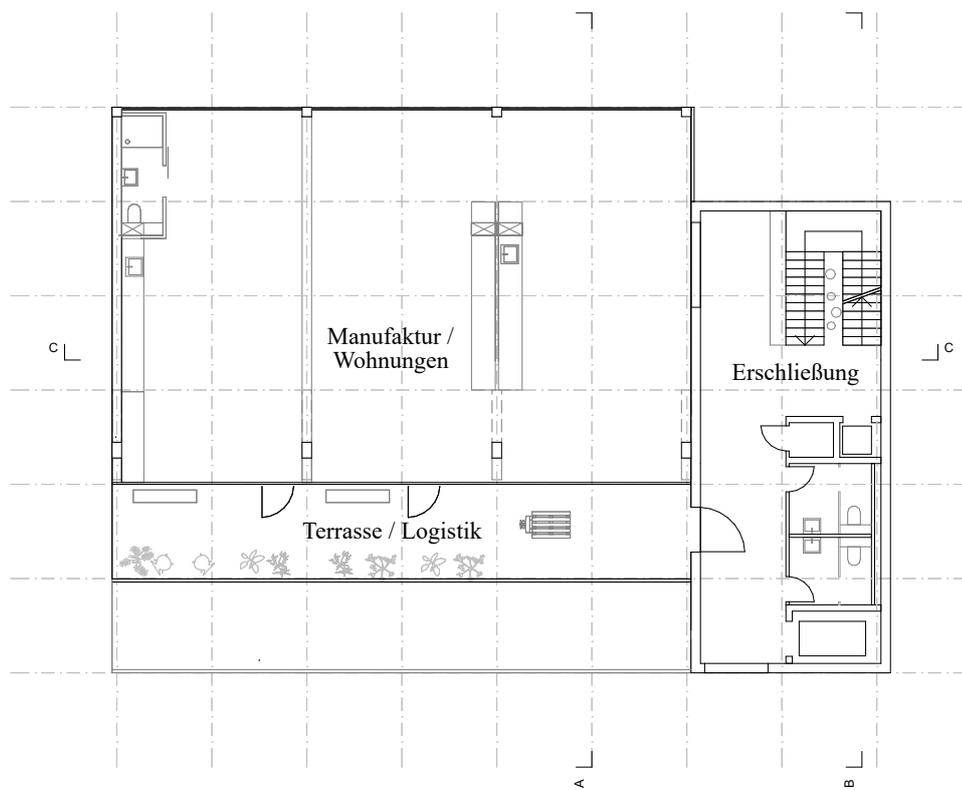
Grundriss Zweites Obergeschoss, M 1:250
